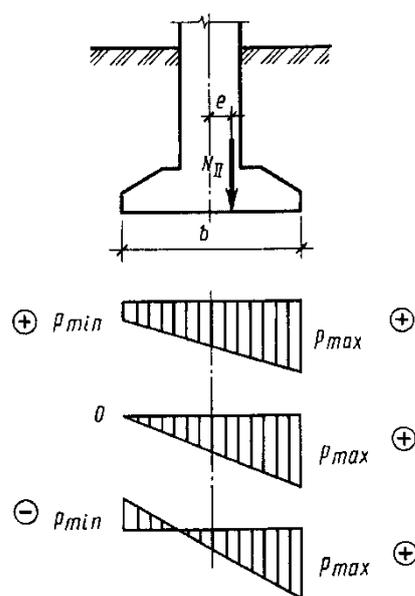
Эпюры давлений под подошвой фундамента при действии внецентренной нагрузки
